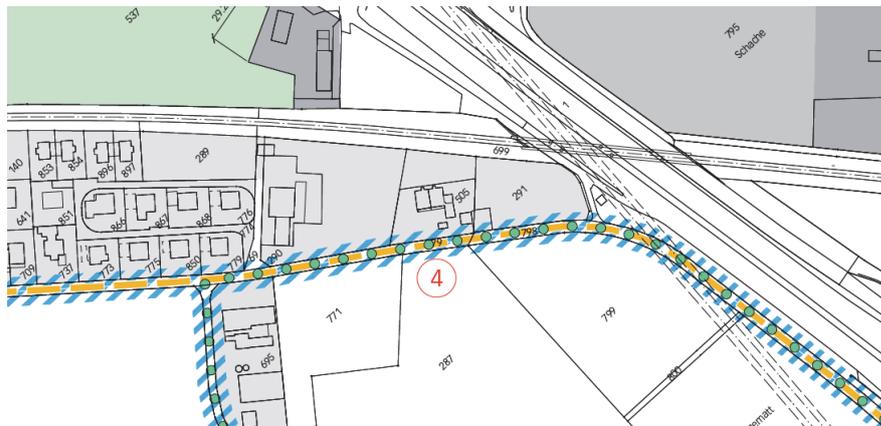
Ausschnitt aus dem Richtplan Verkehr, Plan Massnahmen mit Zone Geschwindigkeitsreduktion neu (M1) (blau schraffiert), Verbesserung Verkehrssicherheit (M4) und hinweisend wichtige (Velo-)Schulwege (orange gestrichelt)
